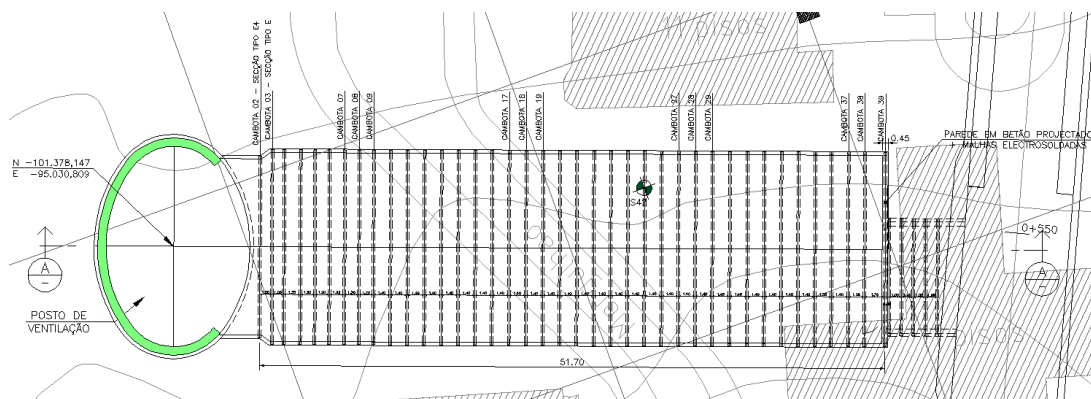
Planta do Túnel de ventilação (adaptado CJC, 2009).
